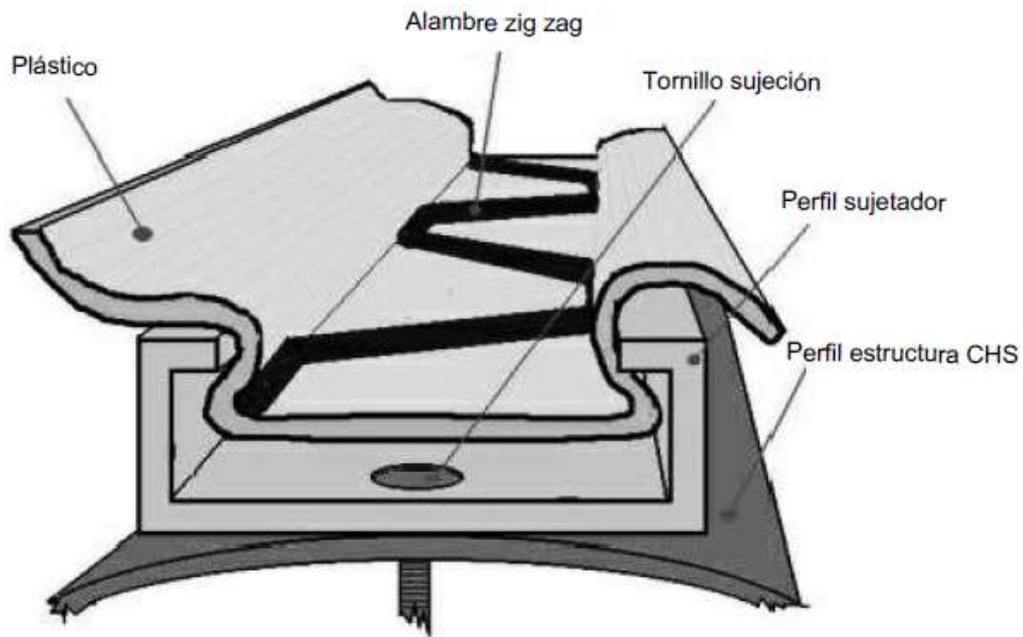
Anclaje del cerramiento plástico a la estructura
